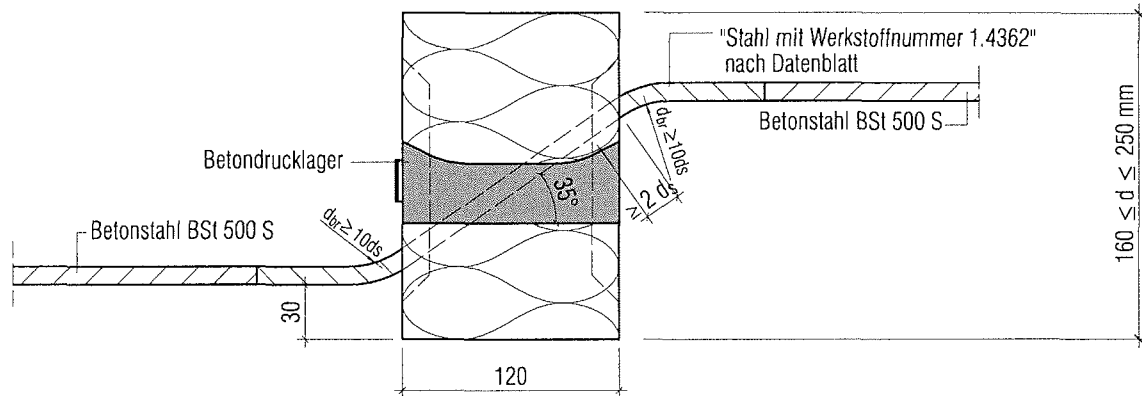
Schöck Isokorb Typ Q mit Betondrucklager
